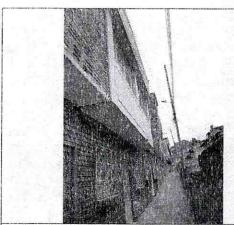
Primer nivel de la edificación emplazada en donde se desarrollará el proyecto ubicado en la Diagonal 38 G Sur No. 11 A - 13.
